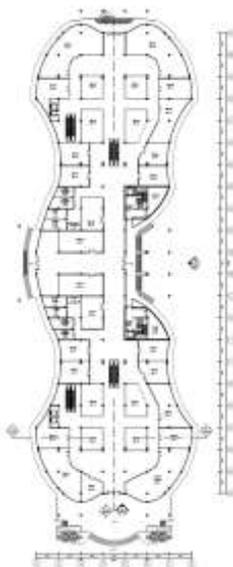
Block Plan dan Konsep Zona Tapak serta Sirkulasi
